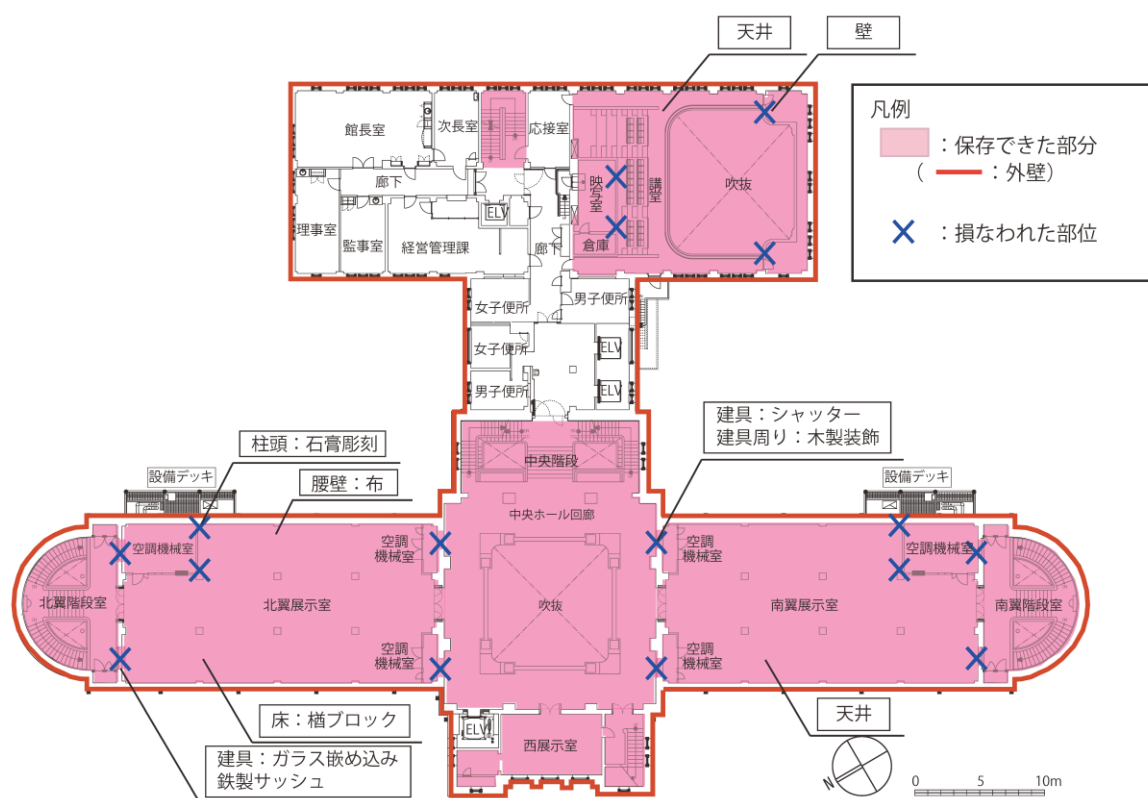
損なわれた文化財的価値 3 階平面図（改修後 3 階平面図に筆者加筆）
